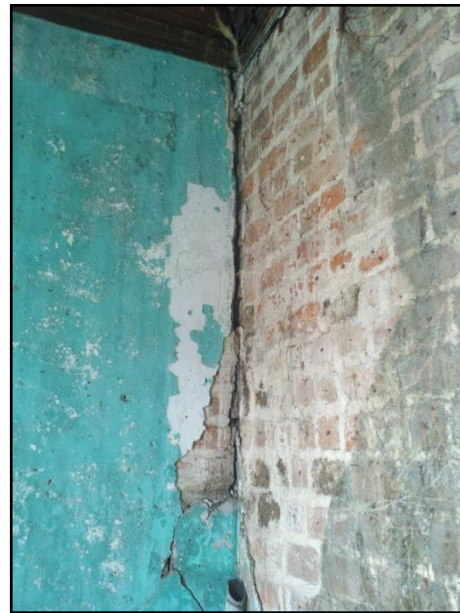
y Figura 5.22 Muestran las fisuras entre paredes perpendiculares.
